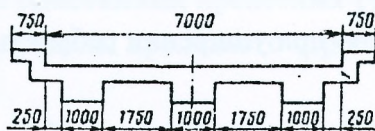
Поперечное сечение плитно-ребристого пролетного строения
